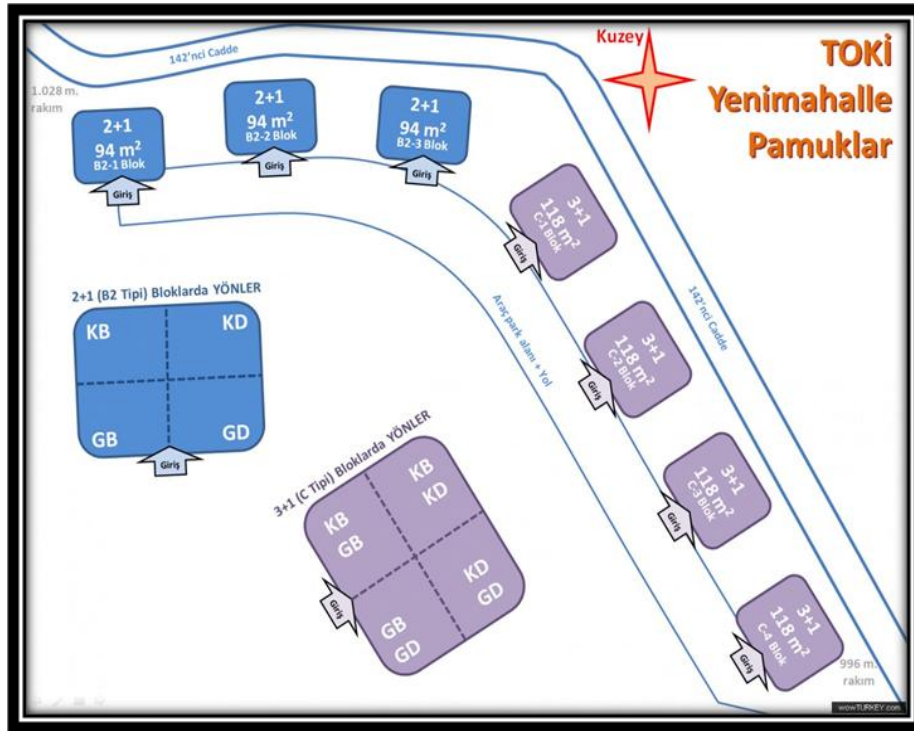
Pamuklar gecekondü dönüşüm uygulaması vaziyet planı (Metroplan 2012).
